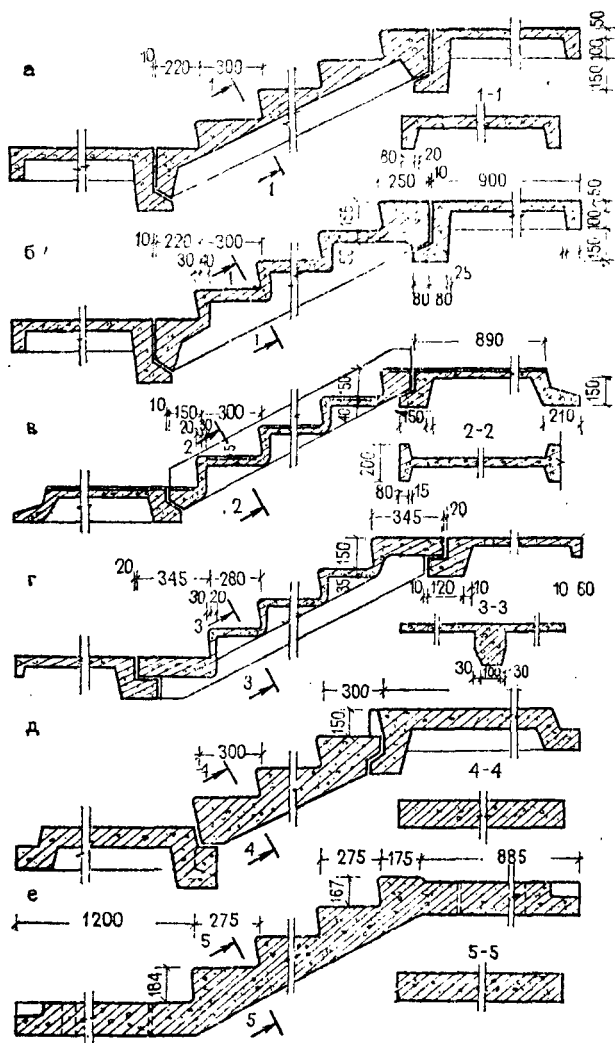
Конструктивные решения железобетонных сборных лестниц из крупных элементов
